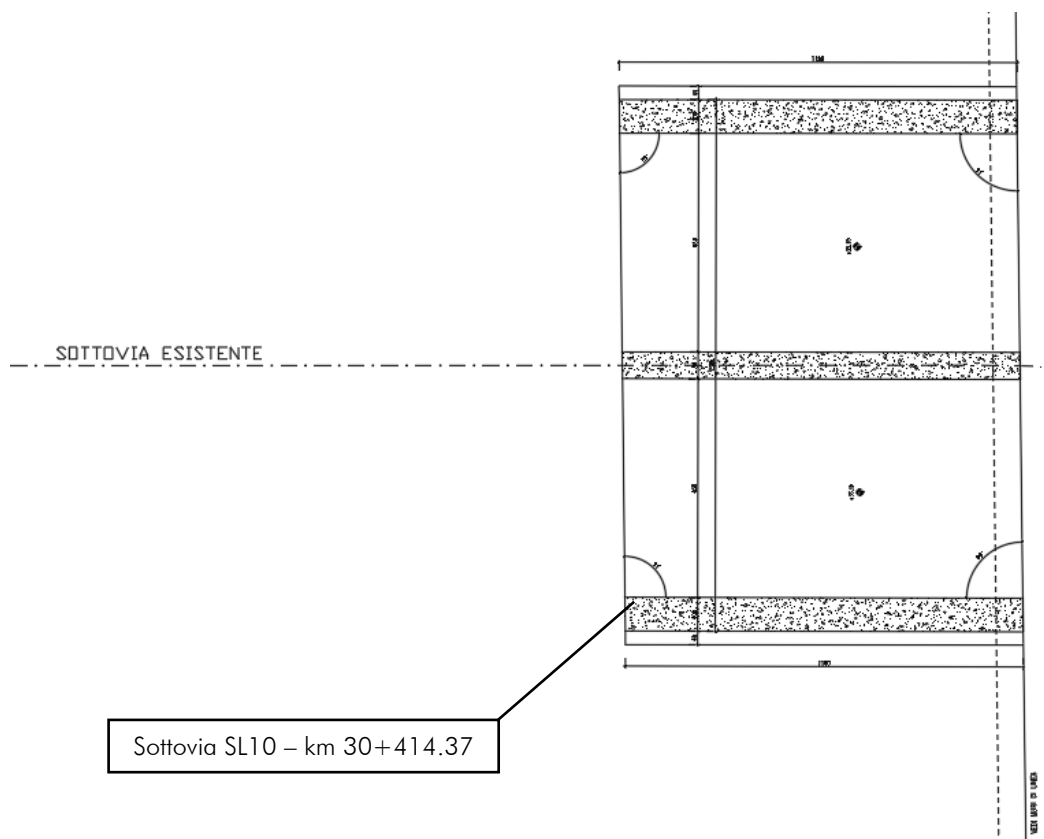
Stralcio planimetrico – Ubicazione sottovia SL10
